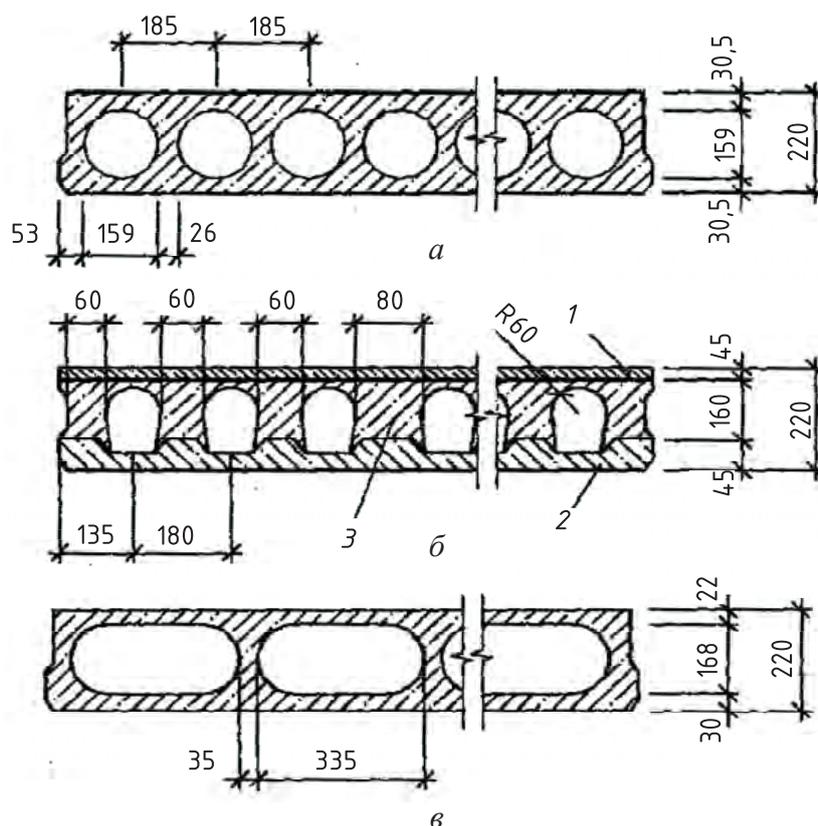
Многупустотные панели перекрытий: *a* — с круглыми пустотами; *б* — изготавливаемые на установках с бетоннующими комбайнами; *в* — с овальными пустотами: 1 — верхний слой; 2 — нижний слой; 3 — средний слой
